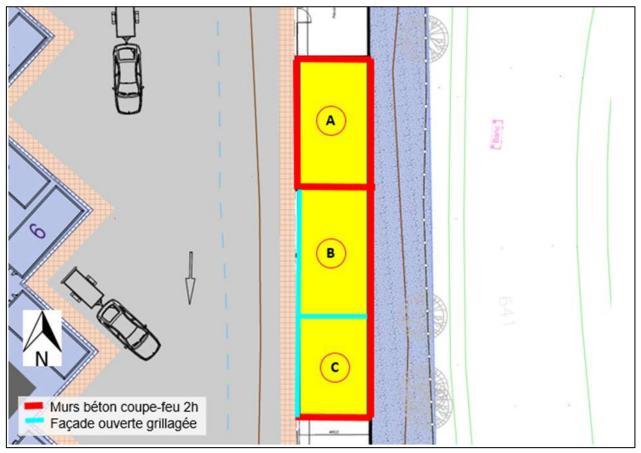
Dispositions constructives des aires de stockages (zone ABC)
